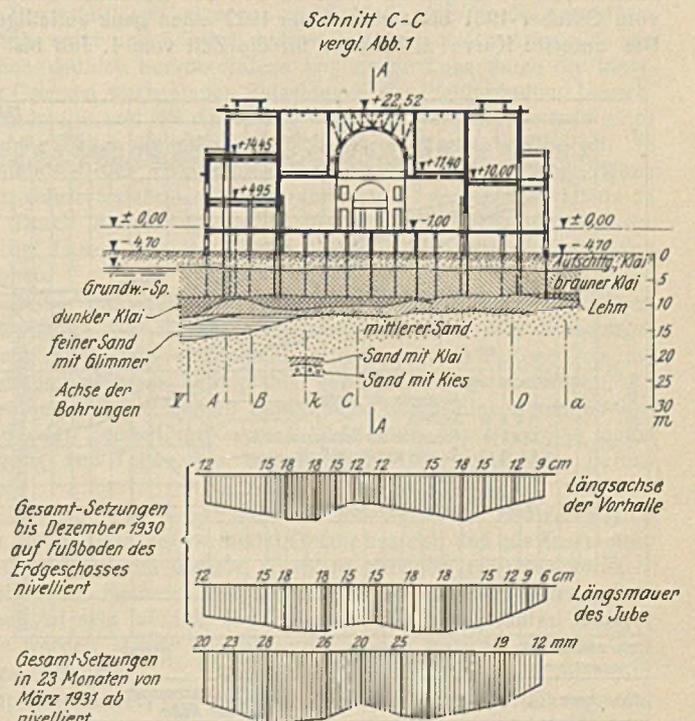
Querschnitt durch die Vorhalle und Setzungen in der Querrichtung.
